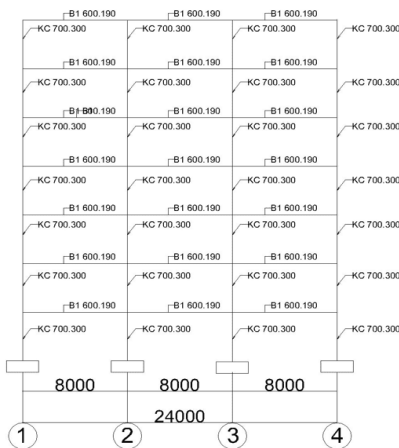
Denah Kolom dan Balok Alternatif Desain
